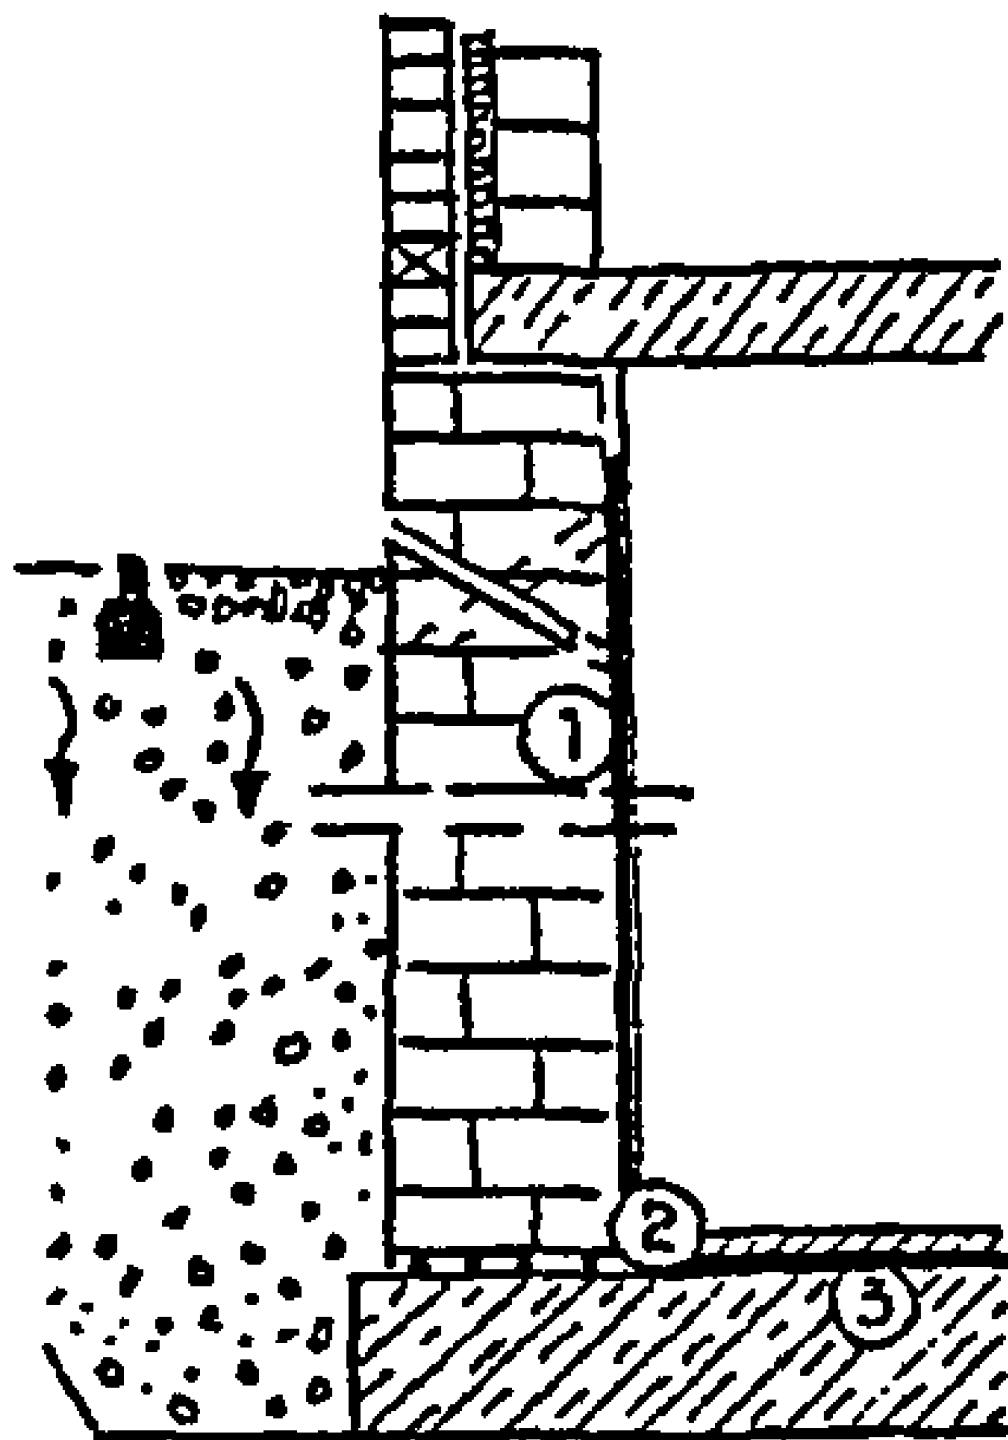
Гидроизоляция подвалов изнутри в уже построенных зданиях:
